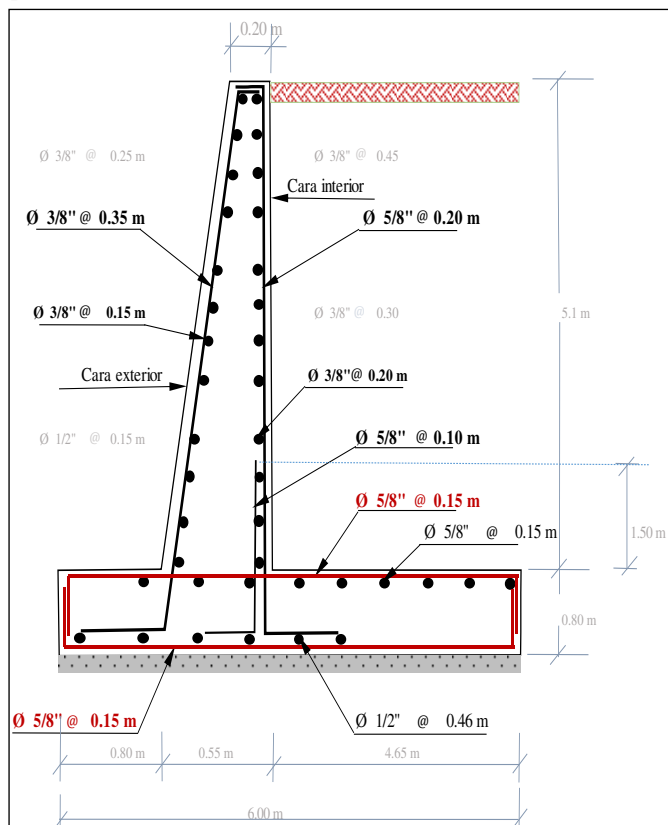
Predimensionamiento de las alas del puenteNota.* Elaboración propia
